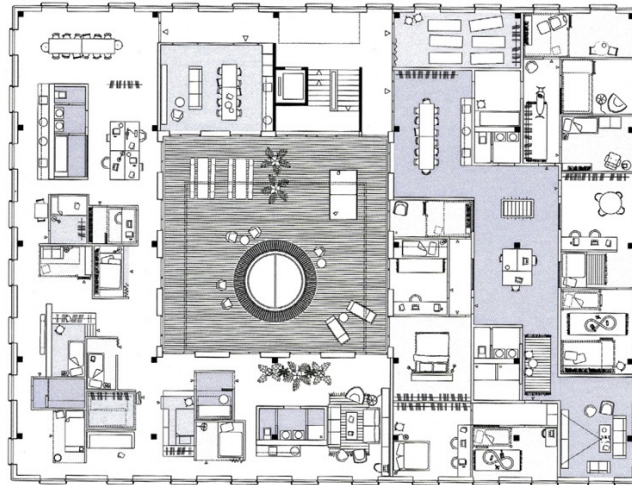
Grundriss Hallenwohnen, Beispiel Zollhaus, Stand Wettbewerb 2015, wird in der Form nicht ausgeführt (Stadt Zürich AHB, 2015, S. 47)
